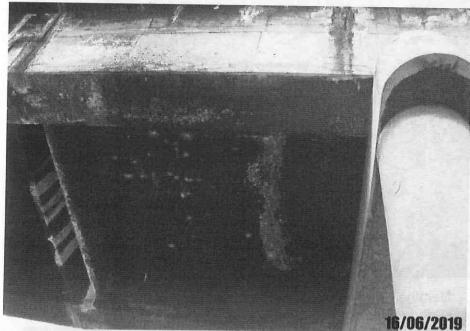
Detalhe da fuligem em uma parte da face inferior do tabuleiro.
